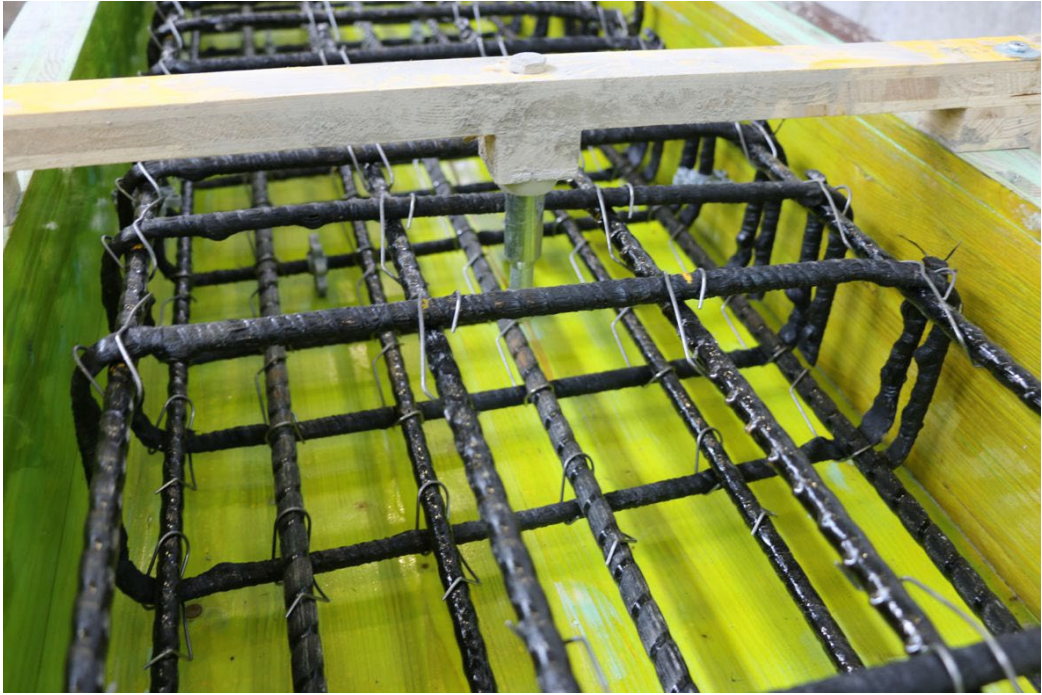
Schalung und Basaltfaser-Bewehrung der Platte 7 vor dem Betonieren. Längsstäbe und Bügel aus Basalt.
